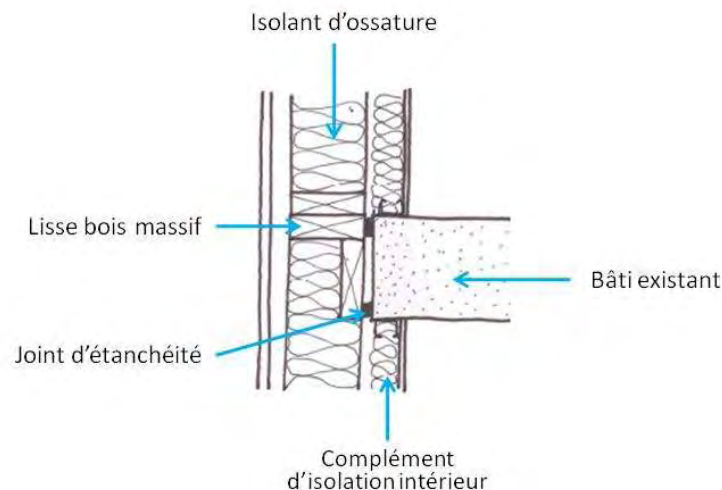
Assemblage bois/béton au droit de la dalle prescrit par le CNDB
